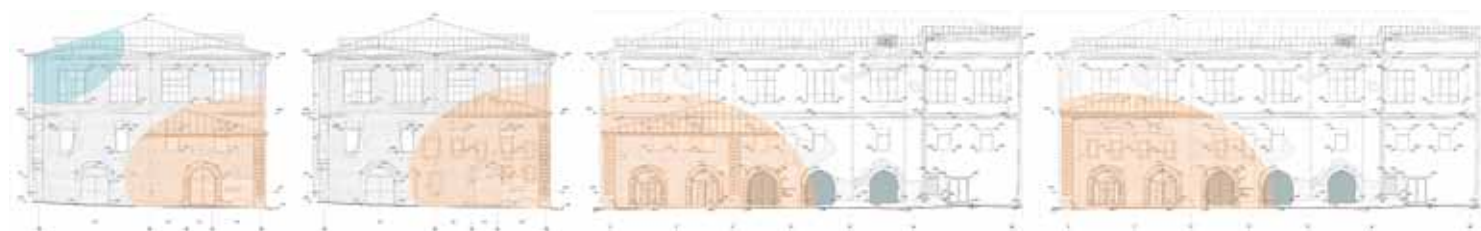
Проецирование графической реконструкции фасадов. Технически может быть осуществлено как на всю плоскость фасада, так и фрагментарно.
